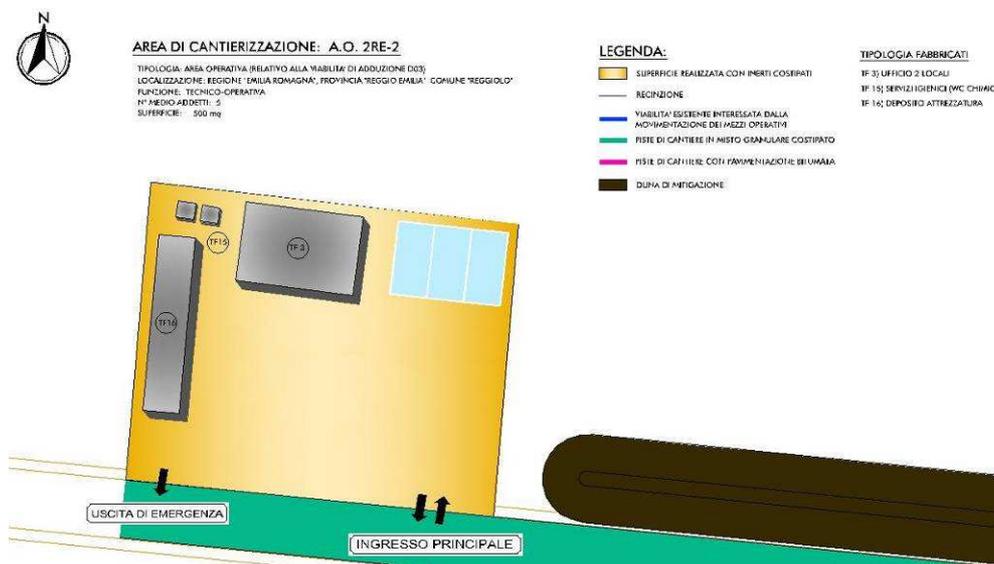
LAYOUT AREE DI CANTIERE OPERATIVE 2RE-2
